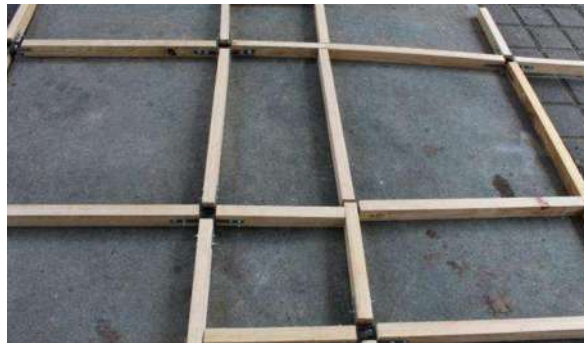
Ensamble de las retículas de piezas solidas de madera con conector metálico.
